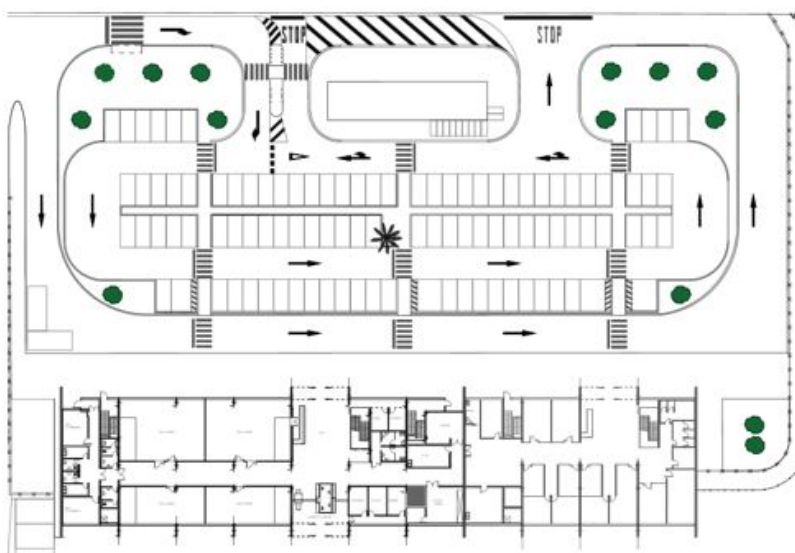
Vista en Planta del Pàrquing de la ampliación
